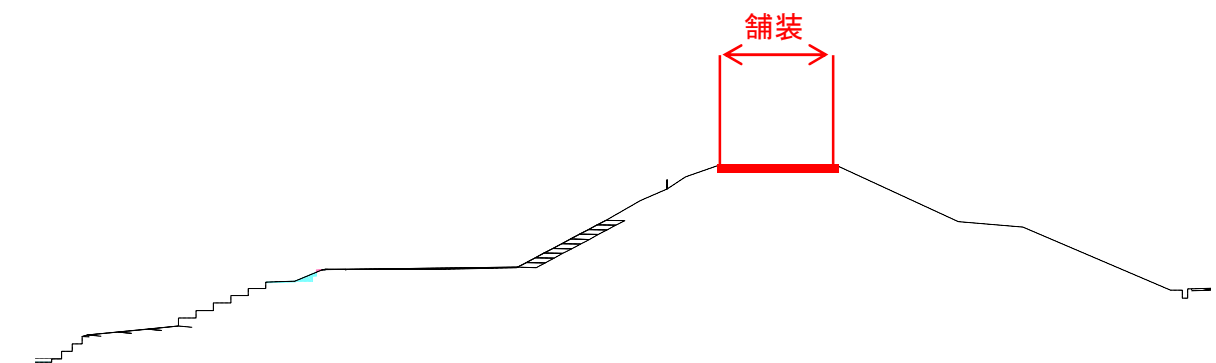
施工イメージ図 (猪名川右岸 2.4k 付近)
